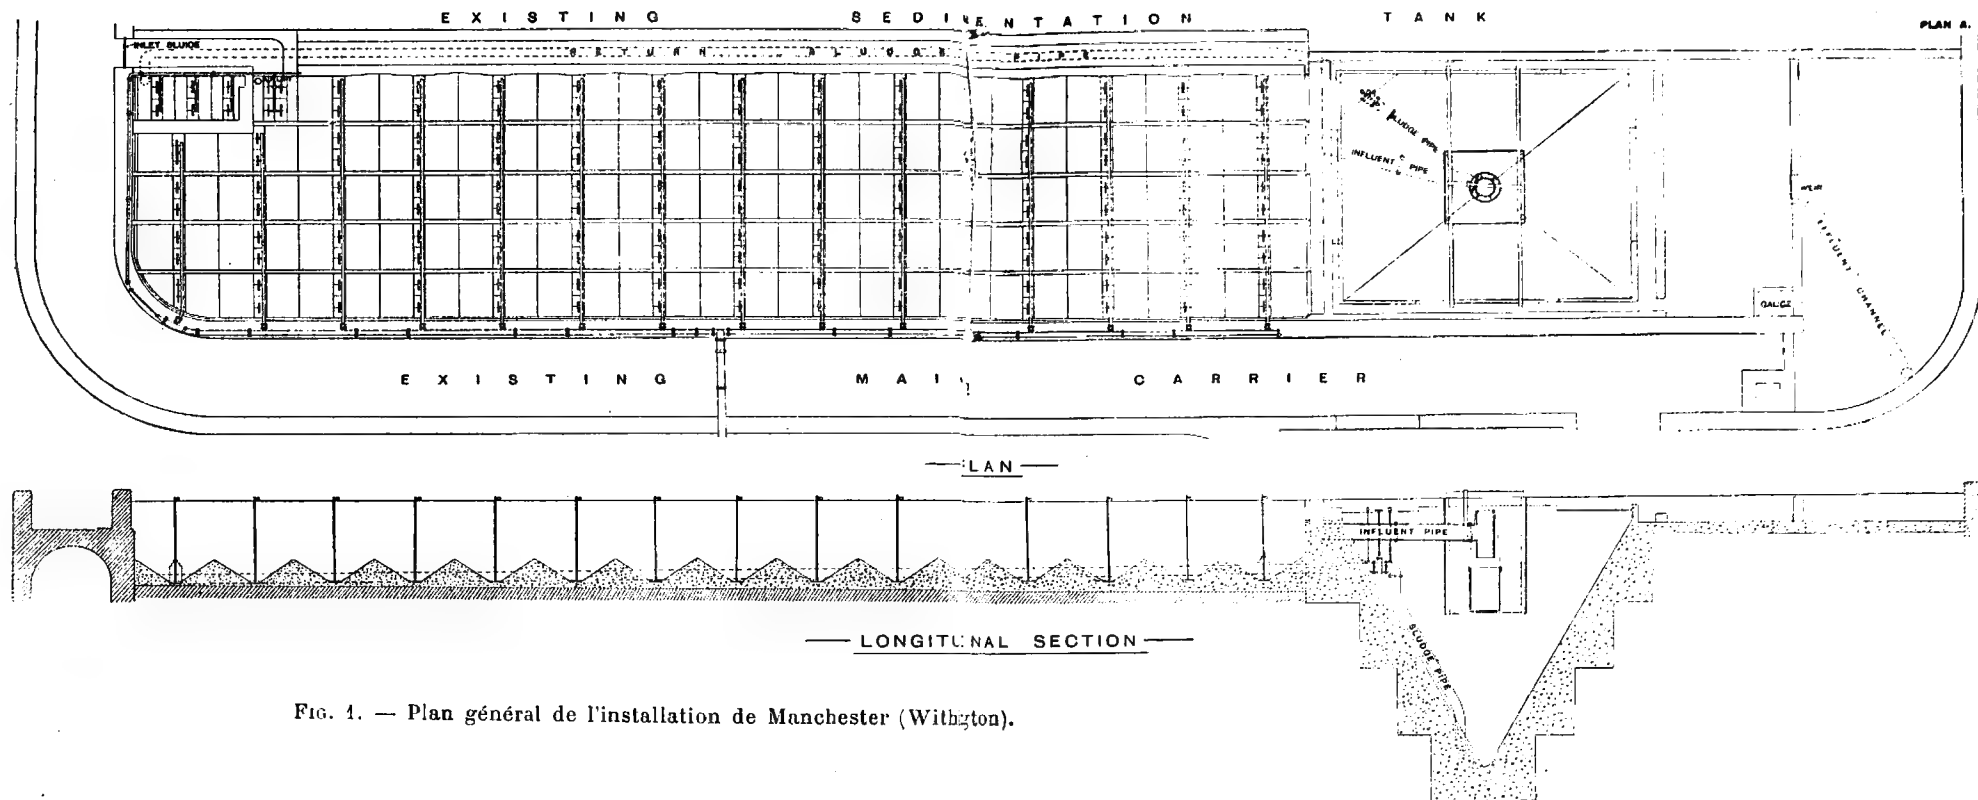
Plan général de l'installation de Manchester (Withington).
